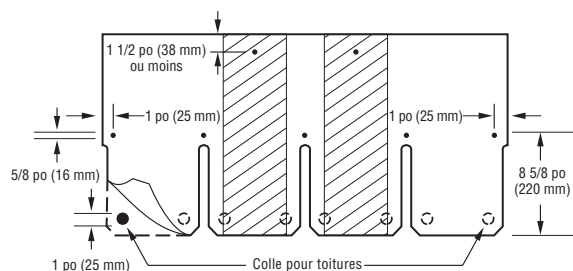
Utilisez sept clous et huit points de ciment asphaltique pour toitures sur les pentes raides.
